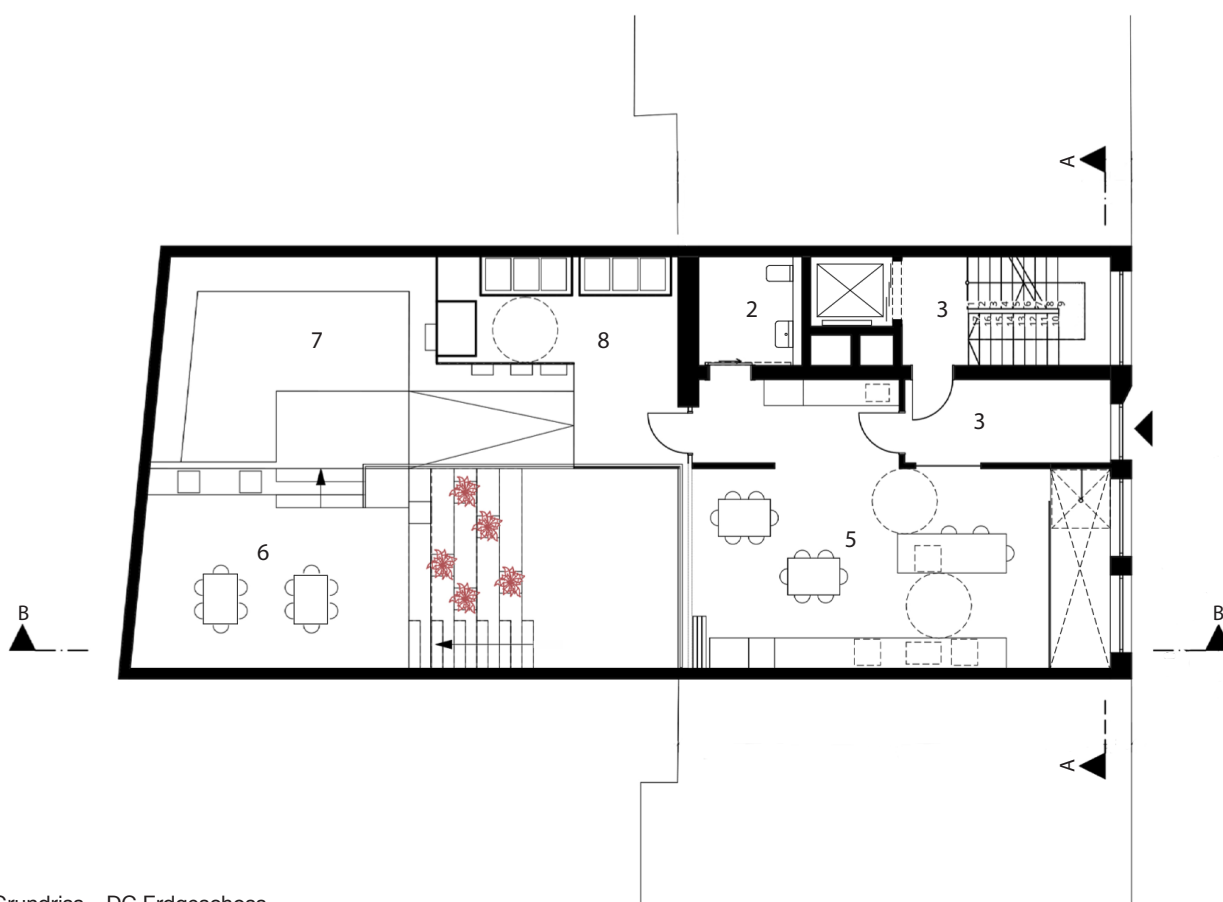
Grundriss – DC Erdgeschoss
